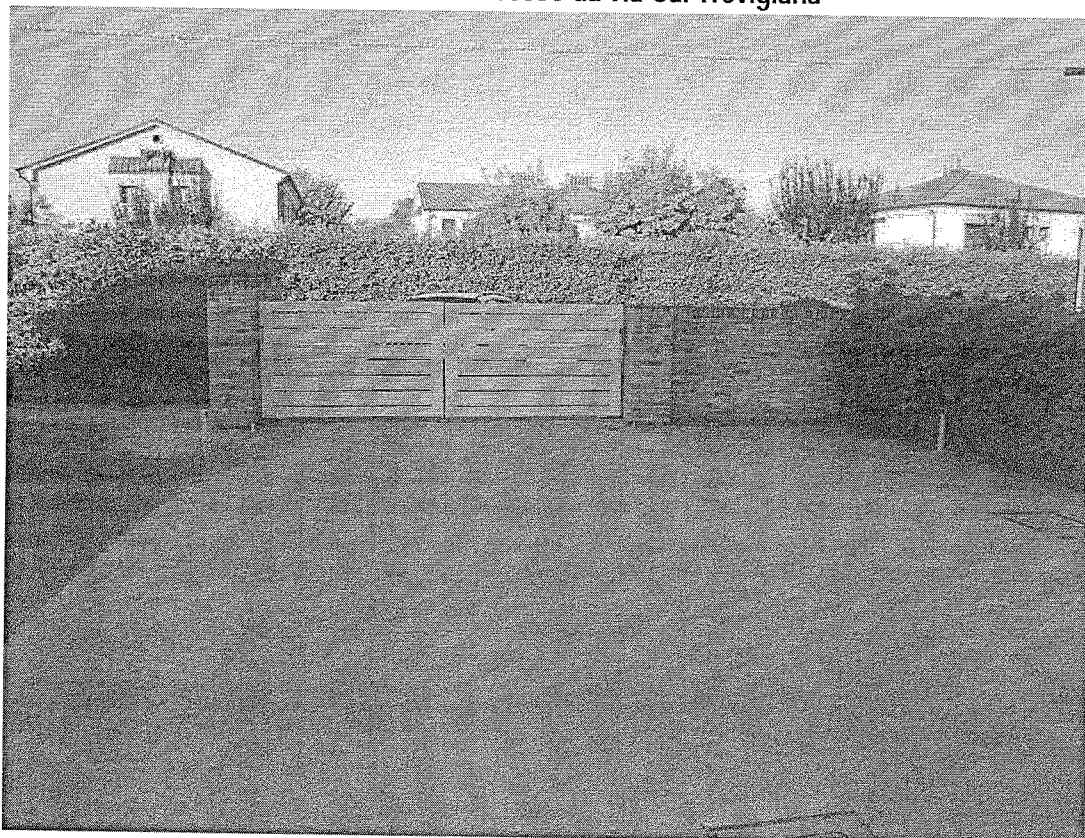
vista da sud-ovest da via Cal Trevigiana
